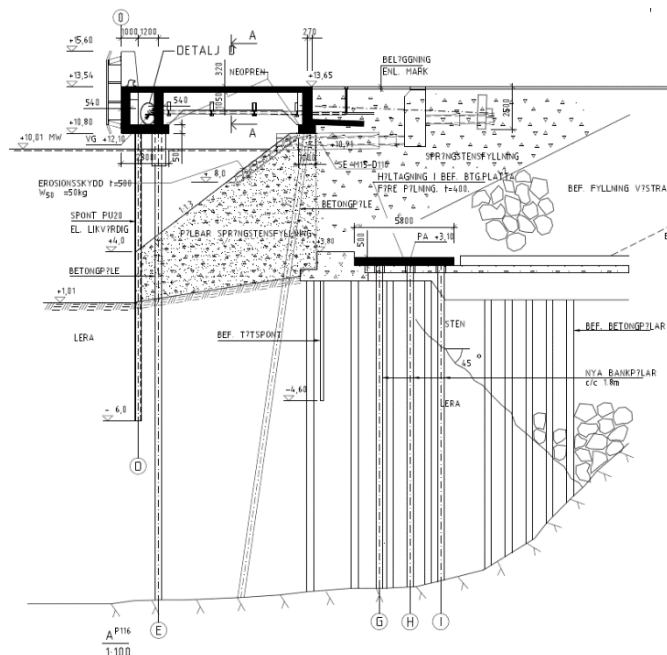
Planritning med befintliga konstruktioner (Port Engineering, 2022-05-09).
